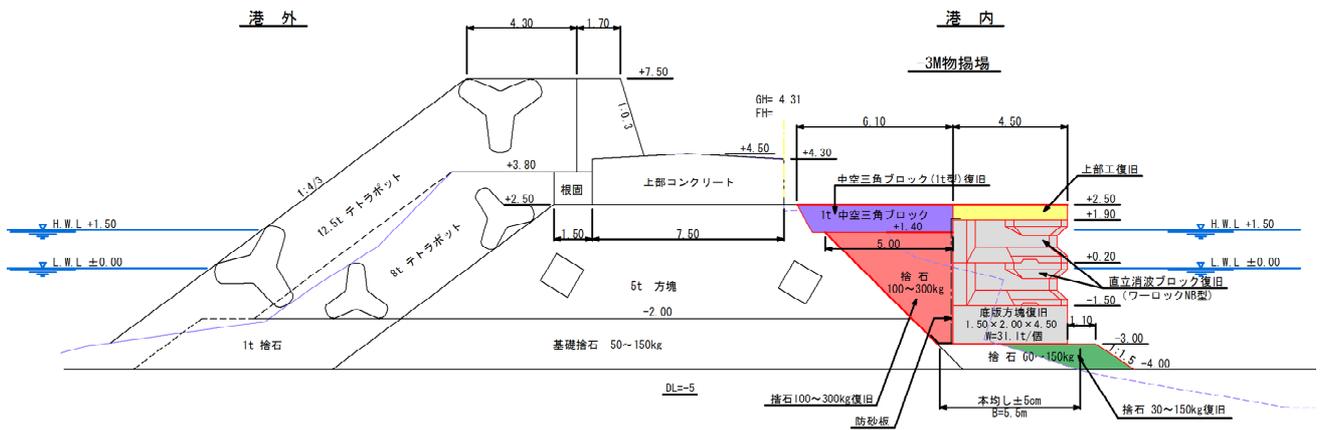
No.31 大洗港区_第1ふ頭 A-2物揚場 (-4.0m) の断面図 (復旧後)
